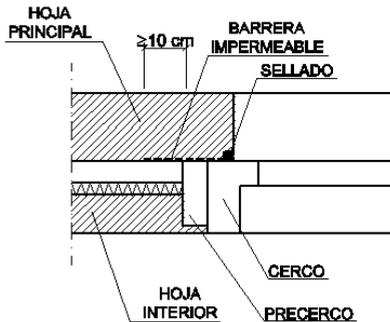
Ejemplo de encuentro de la fachada con la carpintería
